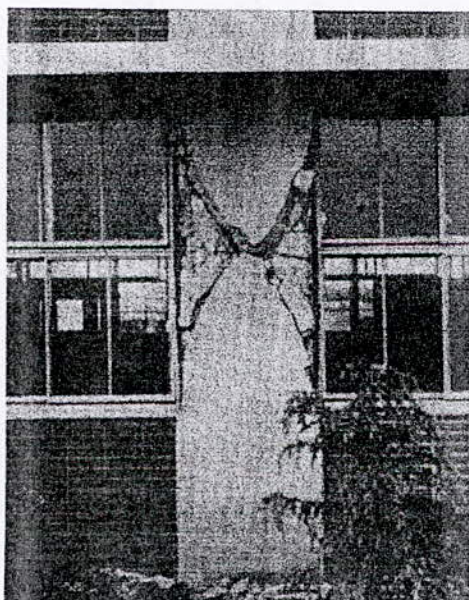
Fissure en X dans les poteaux courts
